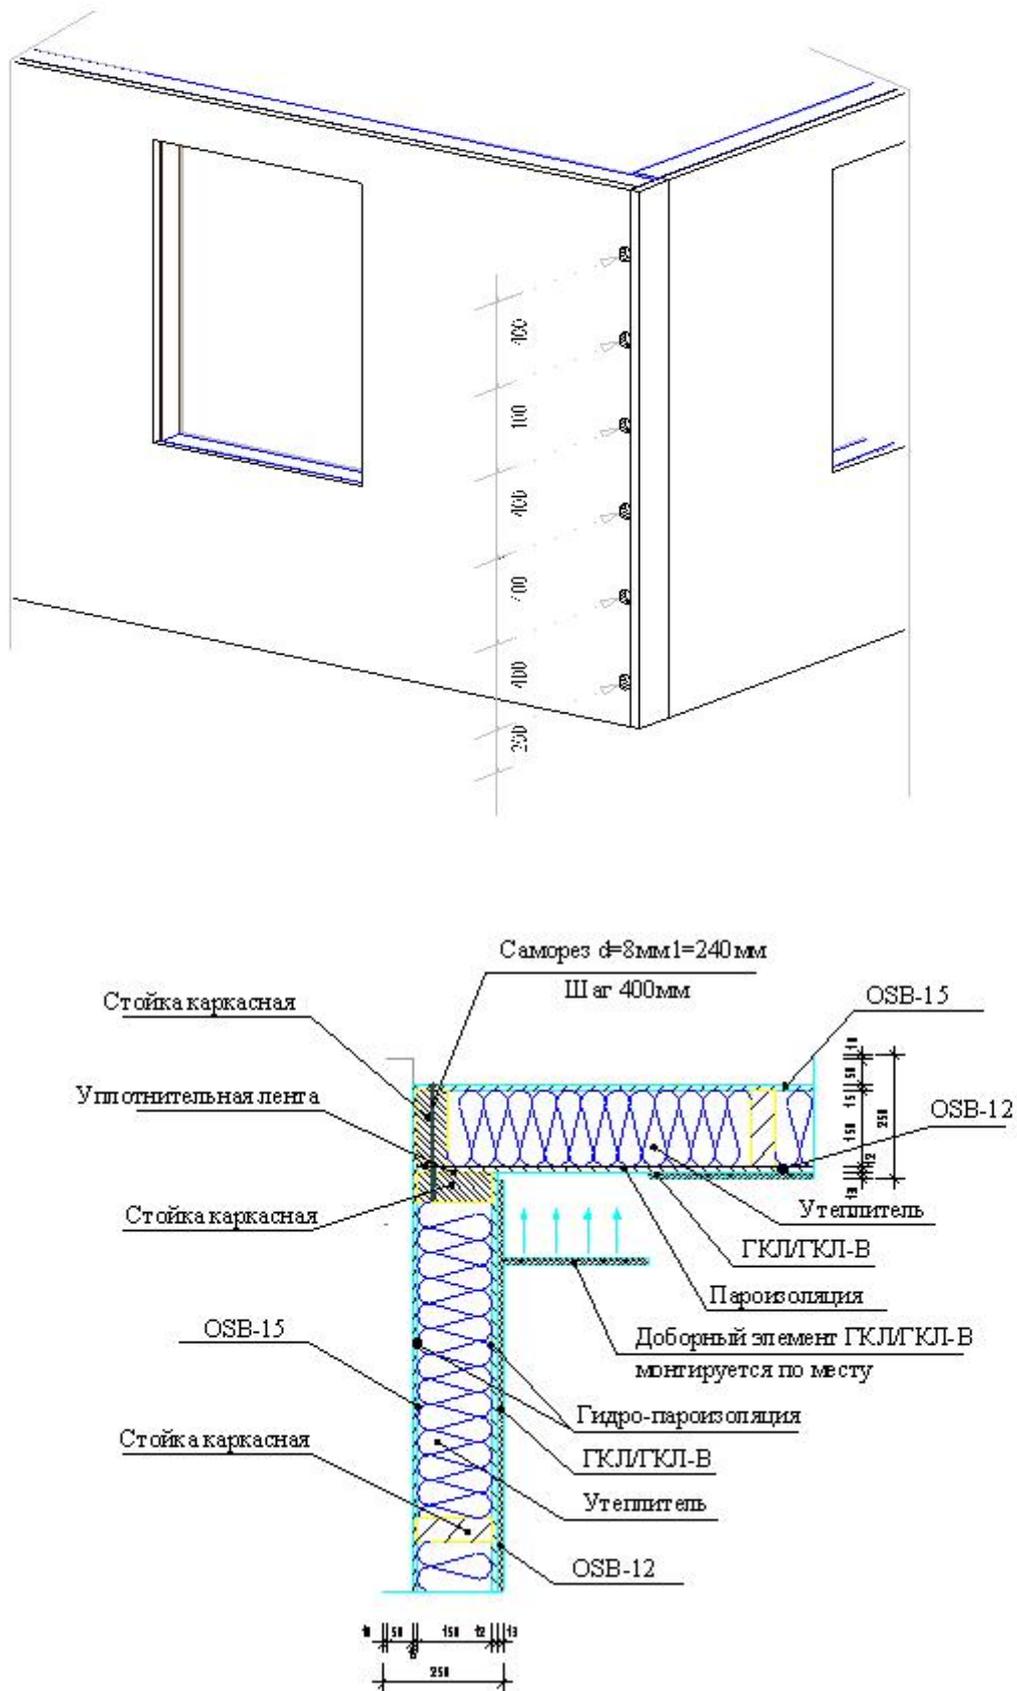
Узел углового крепления наружных стеновых панелей. Тип 1
